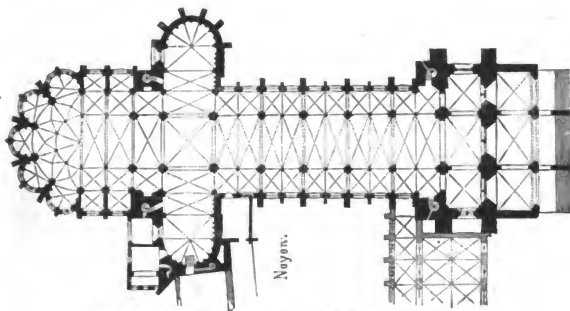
Grundriss der Kathedrale von Noyon. (Nach Viollet-le-Duc.)
